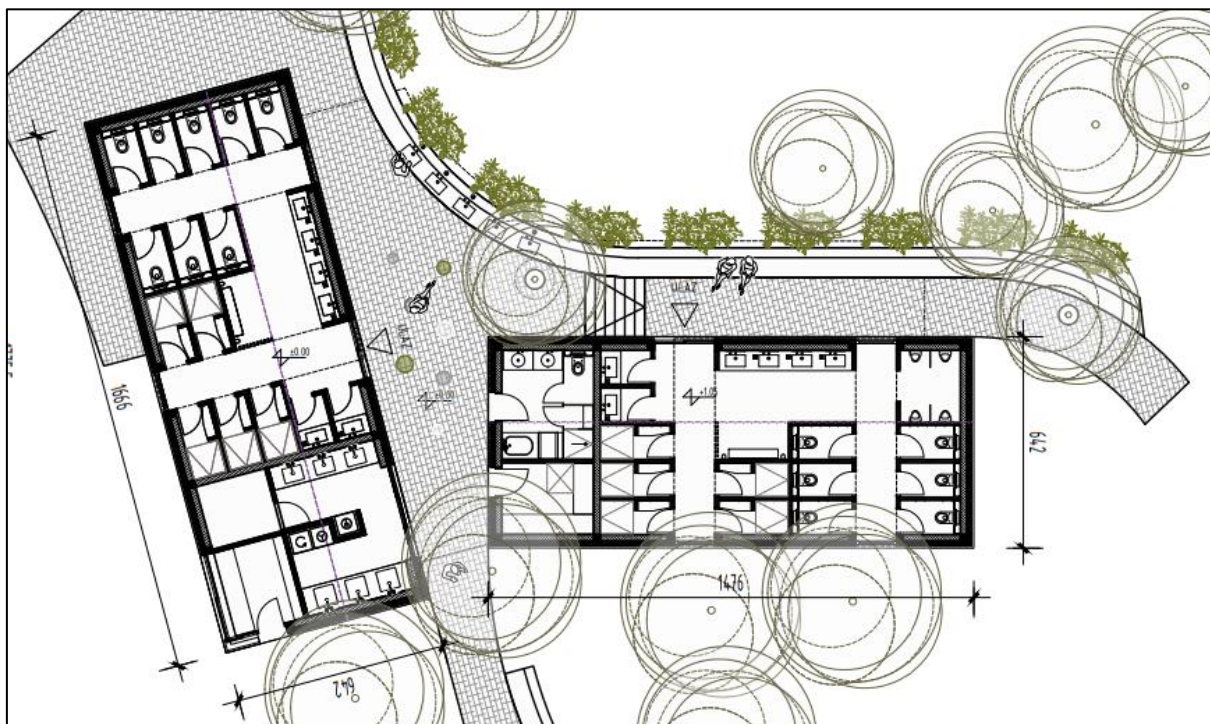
1 Prikaz lokacija izgradnje i planiranih objekata
